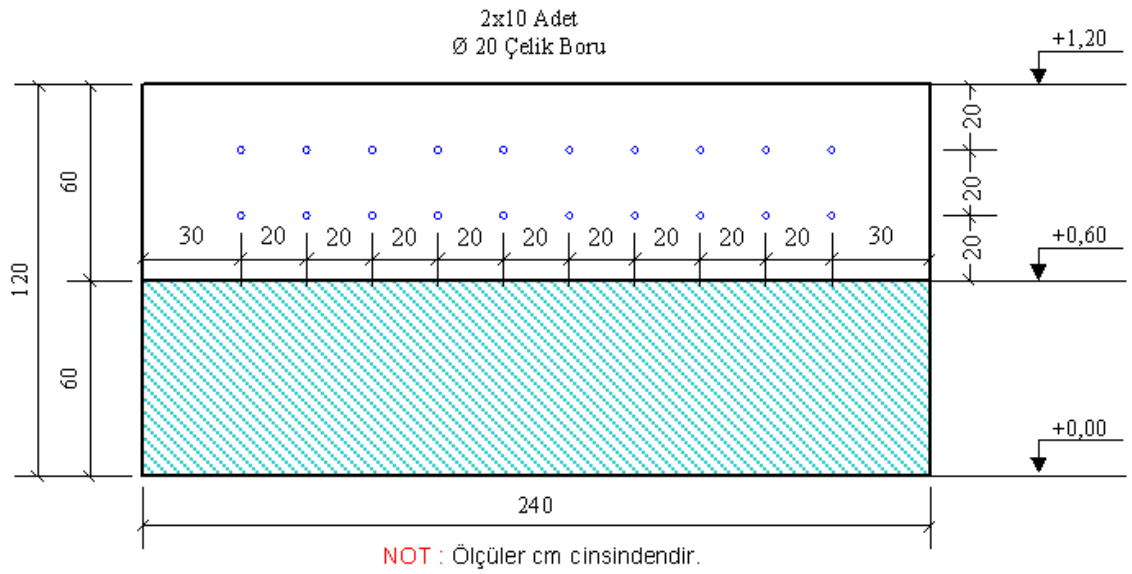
Betonarme çerçeveli sistemde ankraj çubuklarının yerleşim detayı
